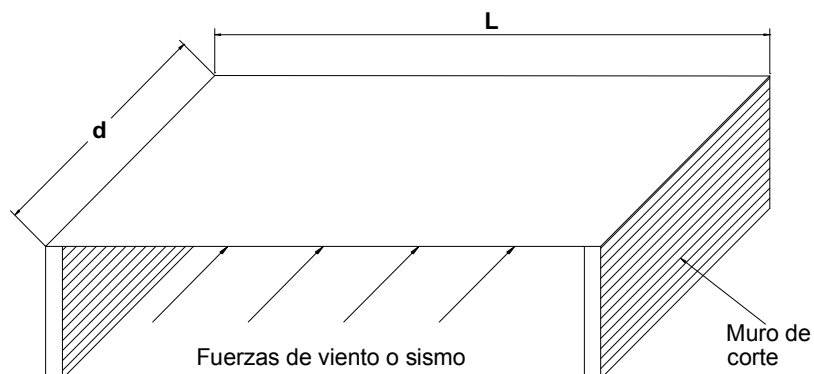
Diafragma horizontal y muros de corte
